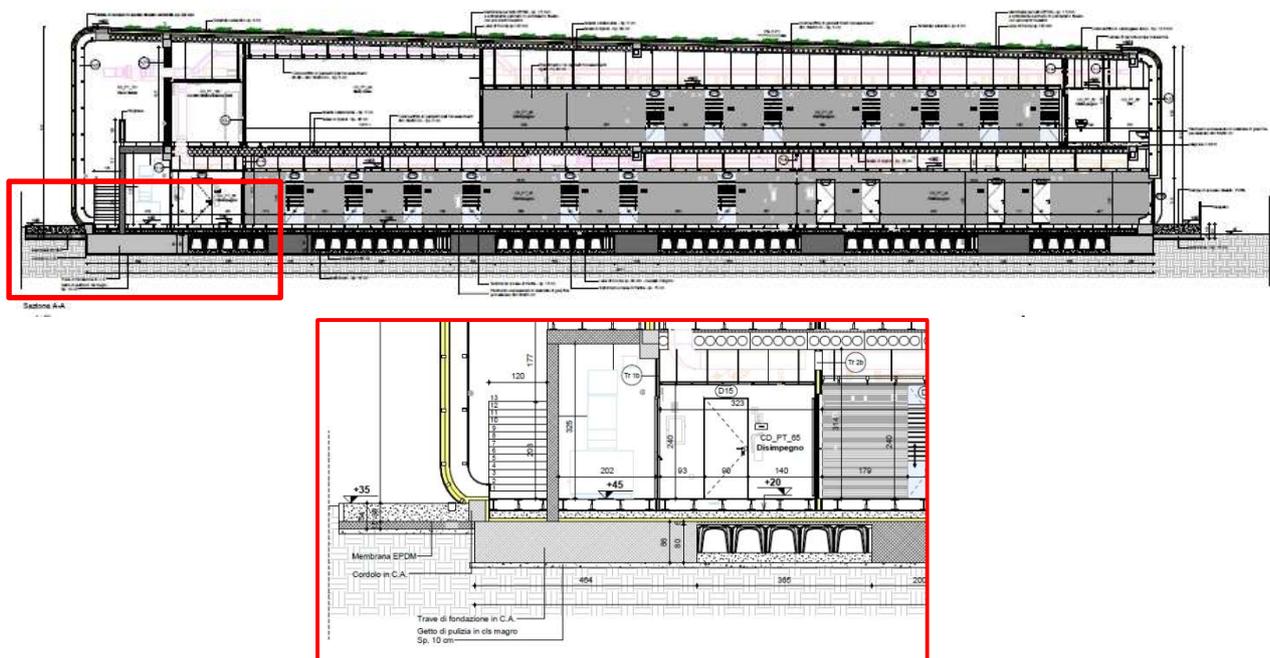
PCC – sezione longitudinale e dettaglio fondamenta
